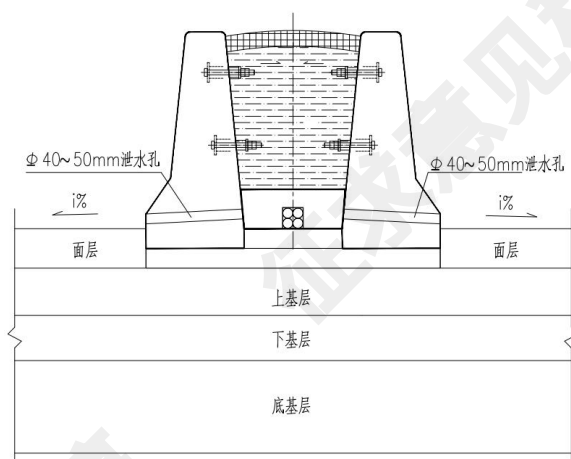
设混凝土防撞护栏的中央分隔带排水示意图
